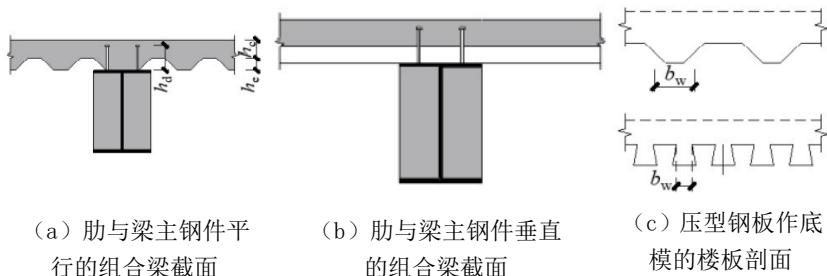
采用压型钢板混凝土组合板做翼板的组合梁示意图
